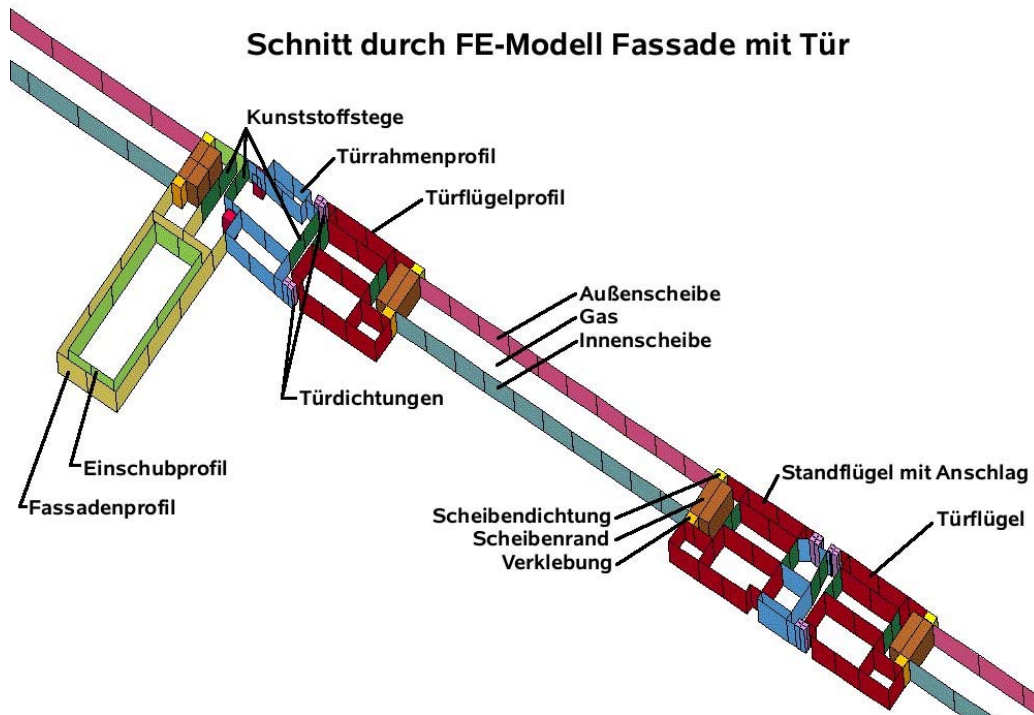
Schnitt durch Fassade mit Profilen und Isolierglasscheibe (FE-Modell)
